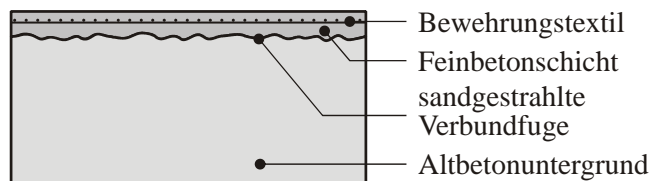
Aufbau eines Verstärkungssystems mit textilbewehrtem Beton
